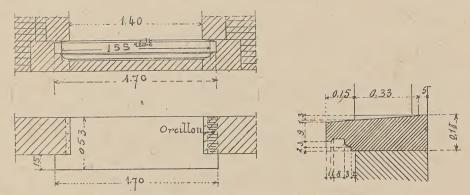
Elévation, plan et coupe de l'appui (baie agrandie).
